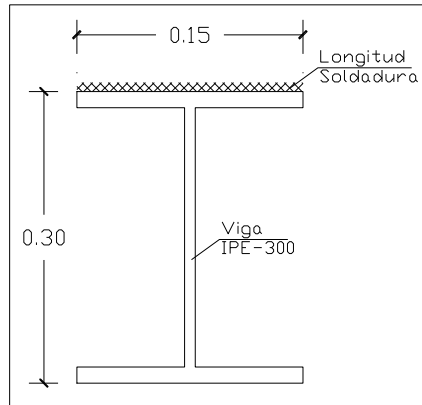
Ubicación de la soldadura a diseñar en el ala de la Viga IPE.
